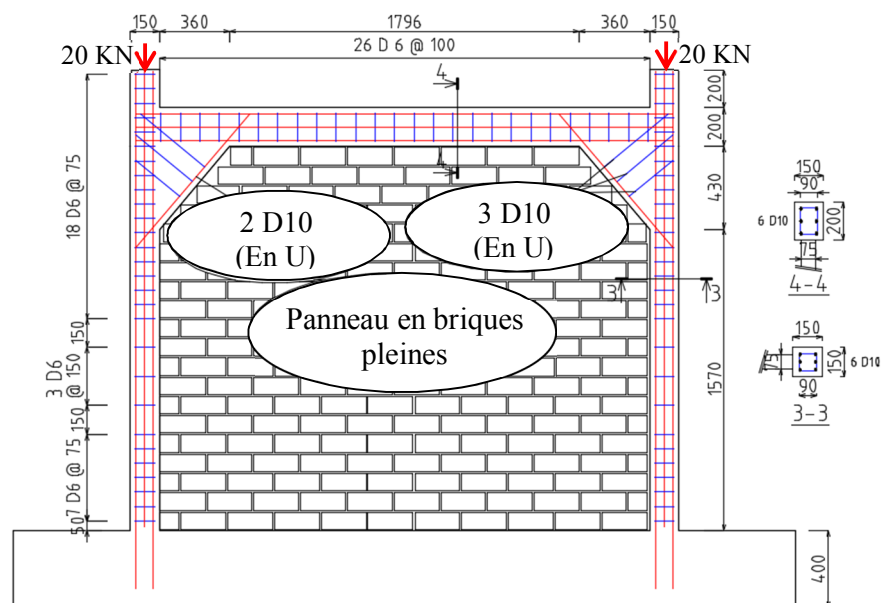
17: Dimensions et ferrailage du spécimen 2 « BAMR avec goussets »
